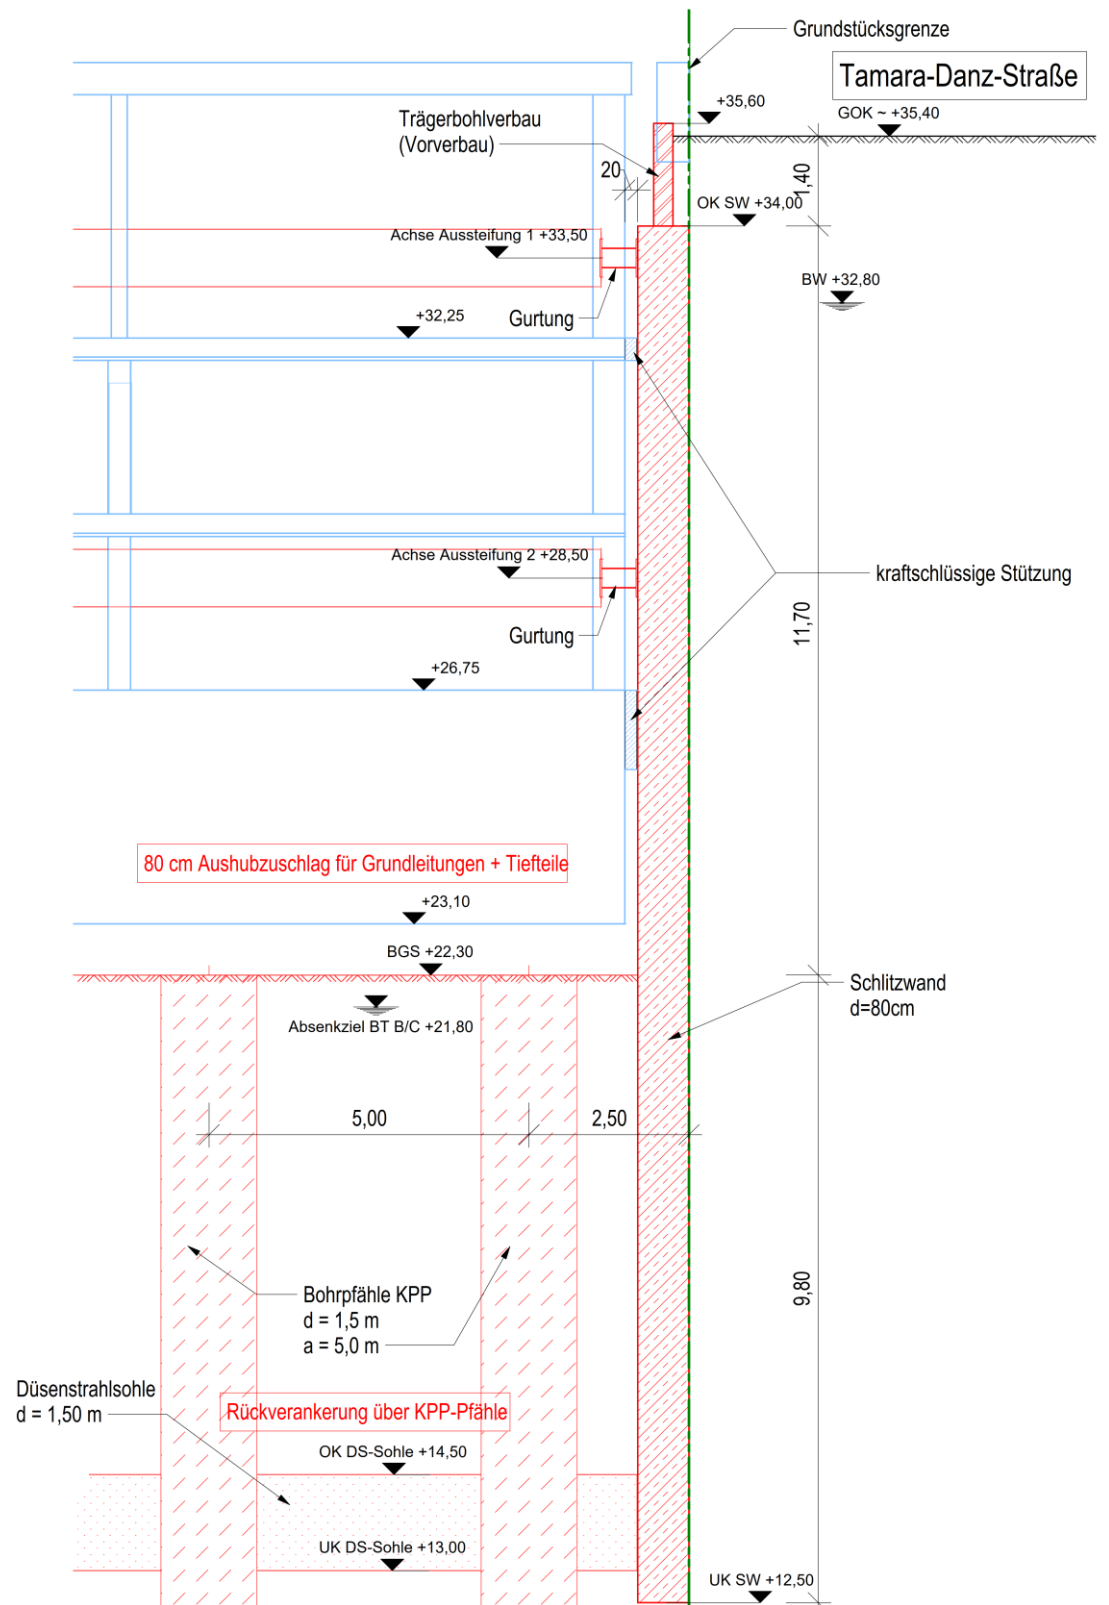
Baugrube Bauteil C – Schnitt 6 (aus [U 7])
